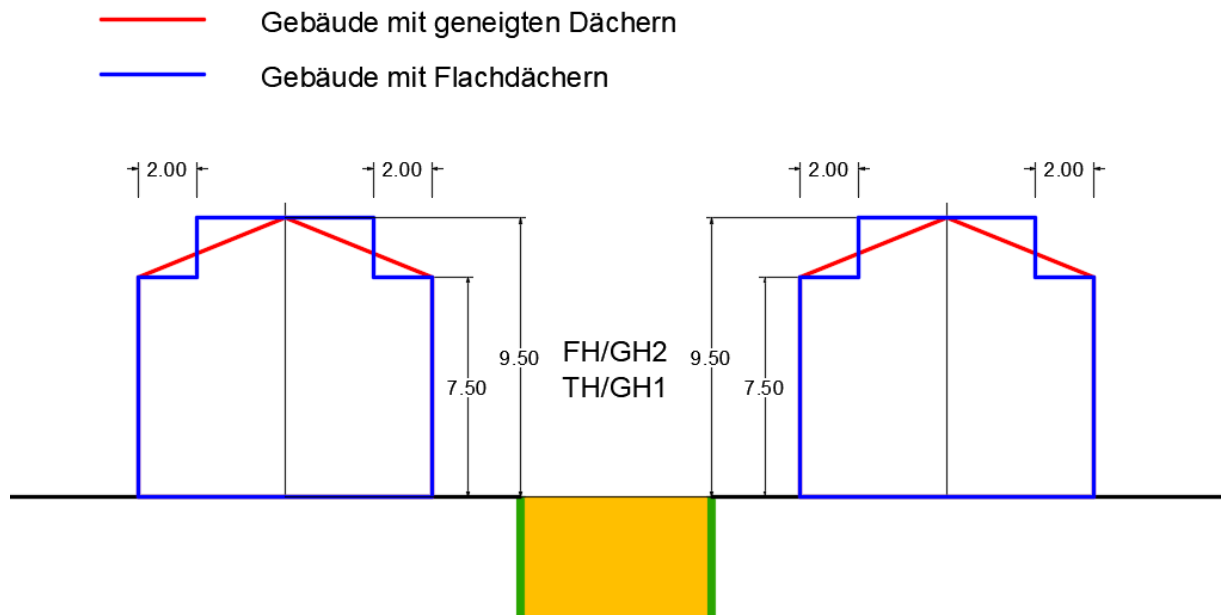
Darstellung der maximalen Traufhöhe/ Firsthöhe/ Gebäudehöhe 1/ Gebäudehöhe 2 bei Gebäuden mit geneigten Dächern/ Gebäuden mit Flachdächern in den Bereichen WA1, WA2, WA 3.
